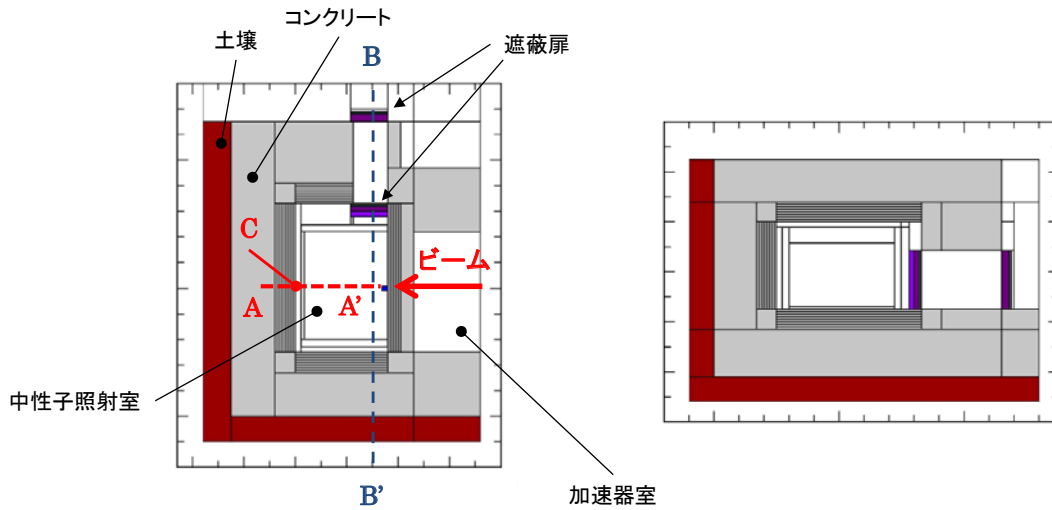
計算モデル (左図：平面図, 右図：BB' における断面図)
